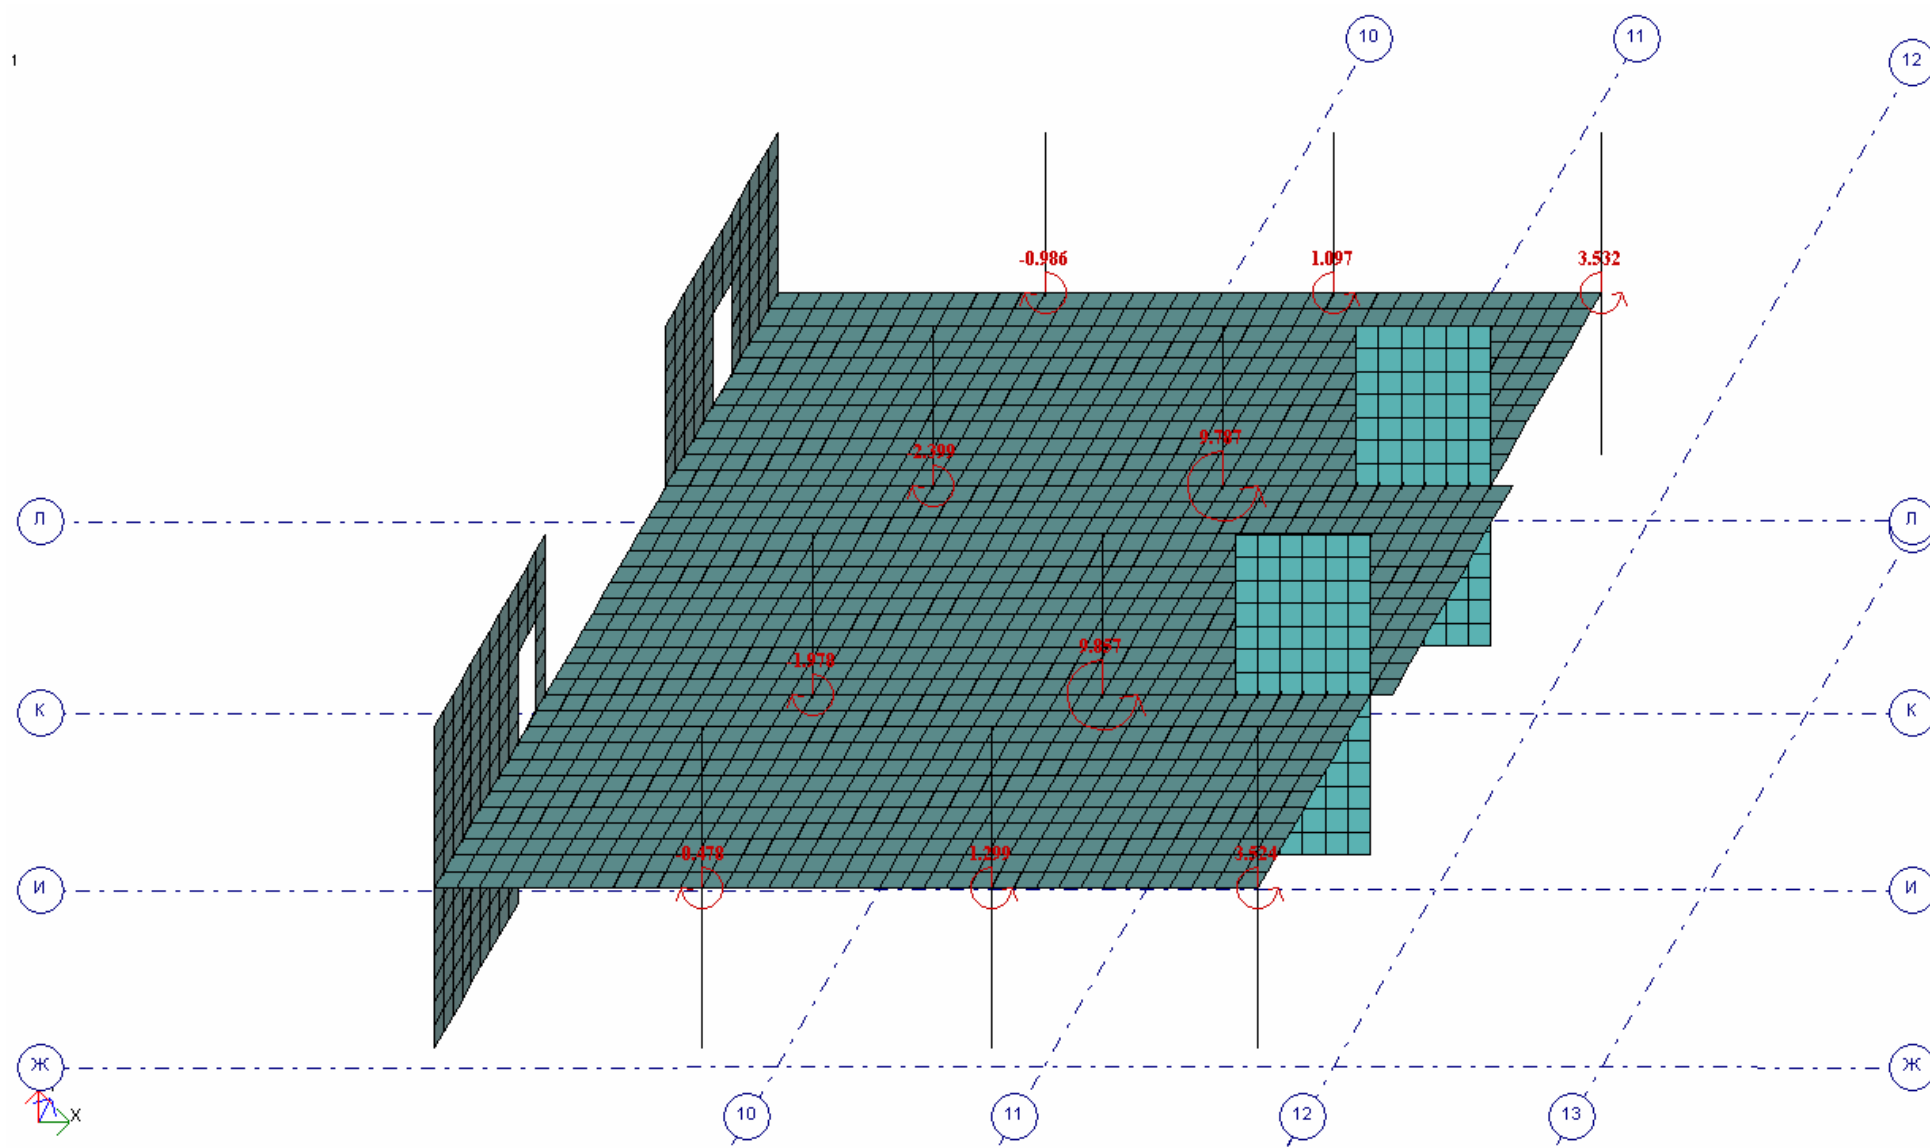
Вид 4 этажа здания с указанием моментов, приложенных к узлам от фрагмента (перекрытия)
